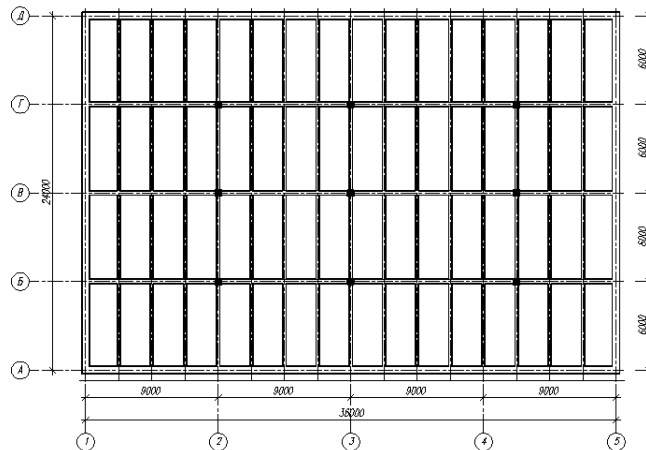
Конструктивная схема монолитного ребристого перекрытия.
